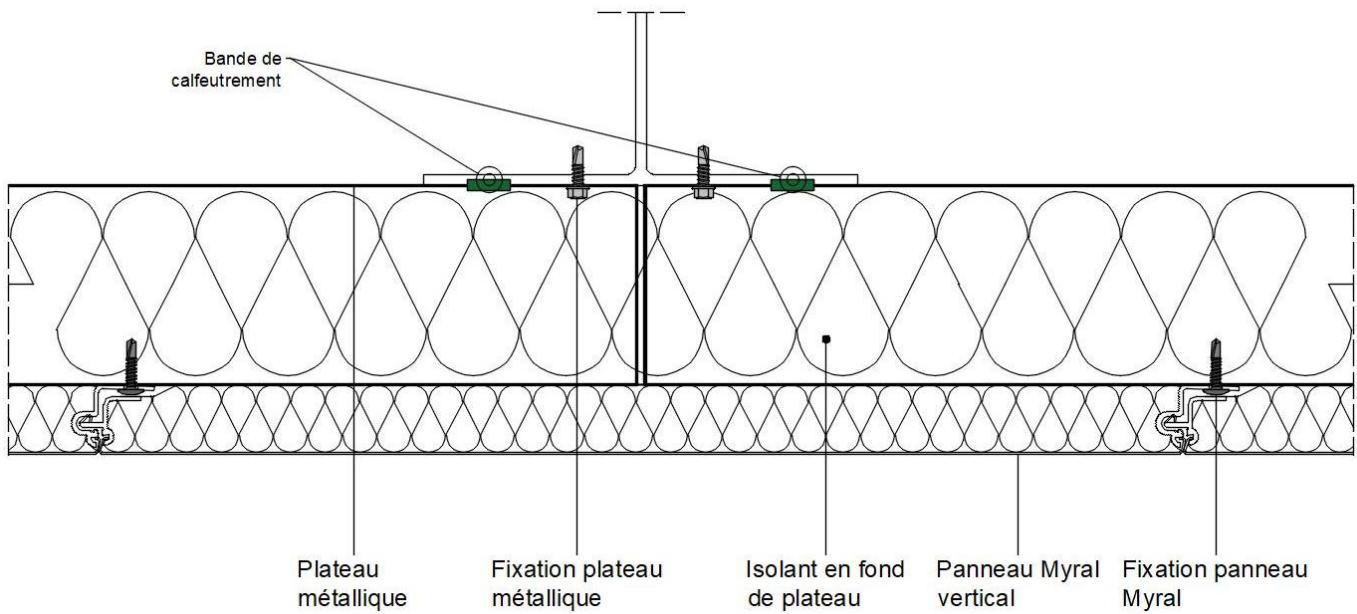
Aboutage des plateaux - (coupe horizontale)
